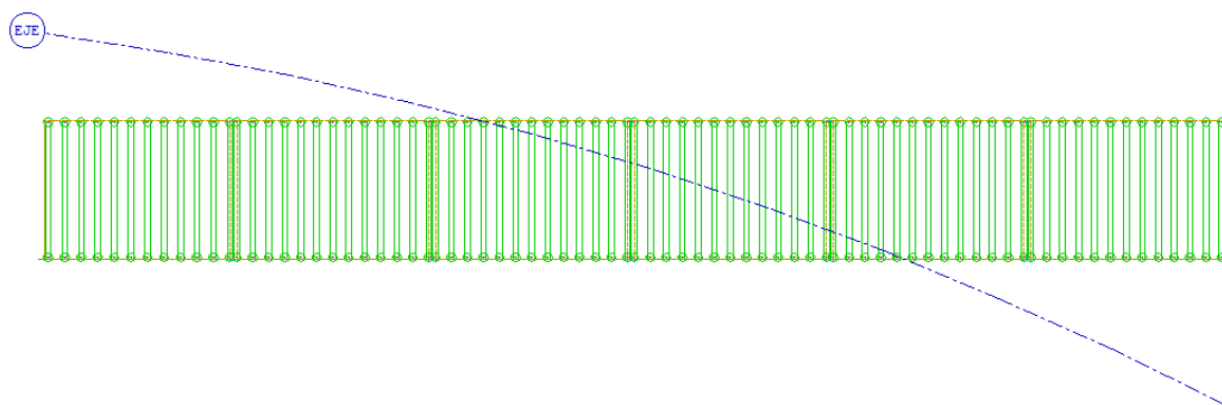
Planta del modelo, con eje longitudinal de la calzada.
